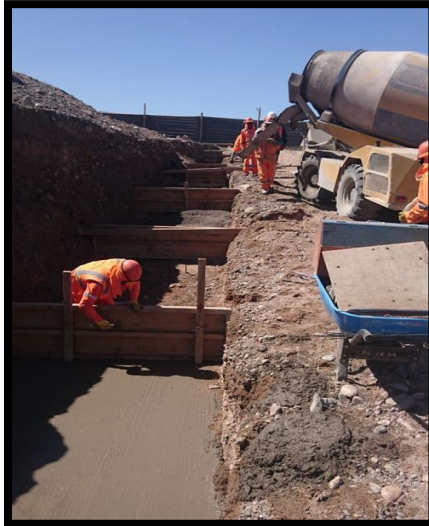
Vaciado de SUB ZAPATA CONCRETO F´C=100 Kg/CM2 + 50% PIEDRA GRANDE
